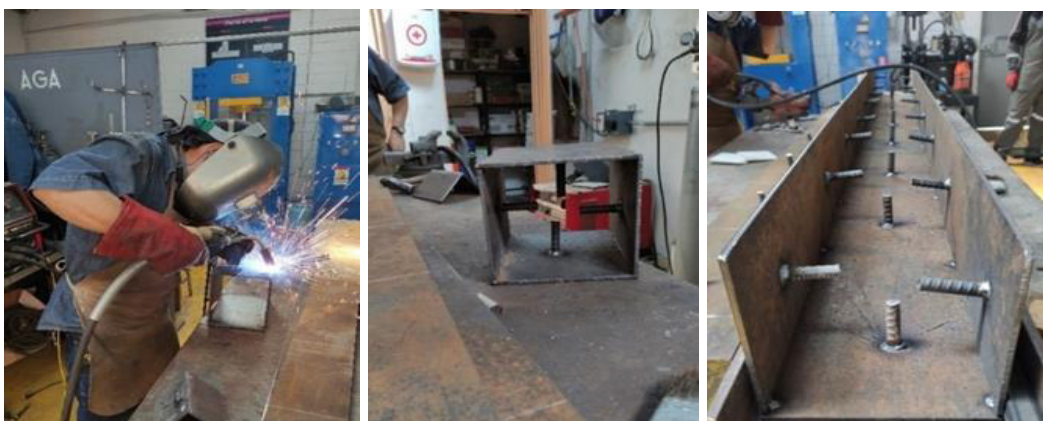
Punteado de placas de la columna y la conexión del pórtico de este trabajo.
